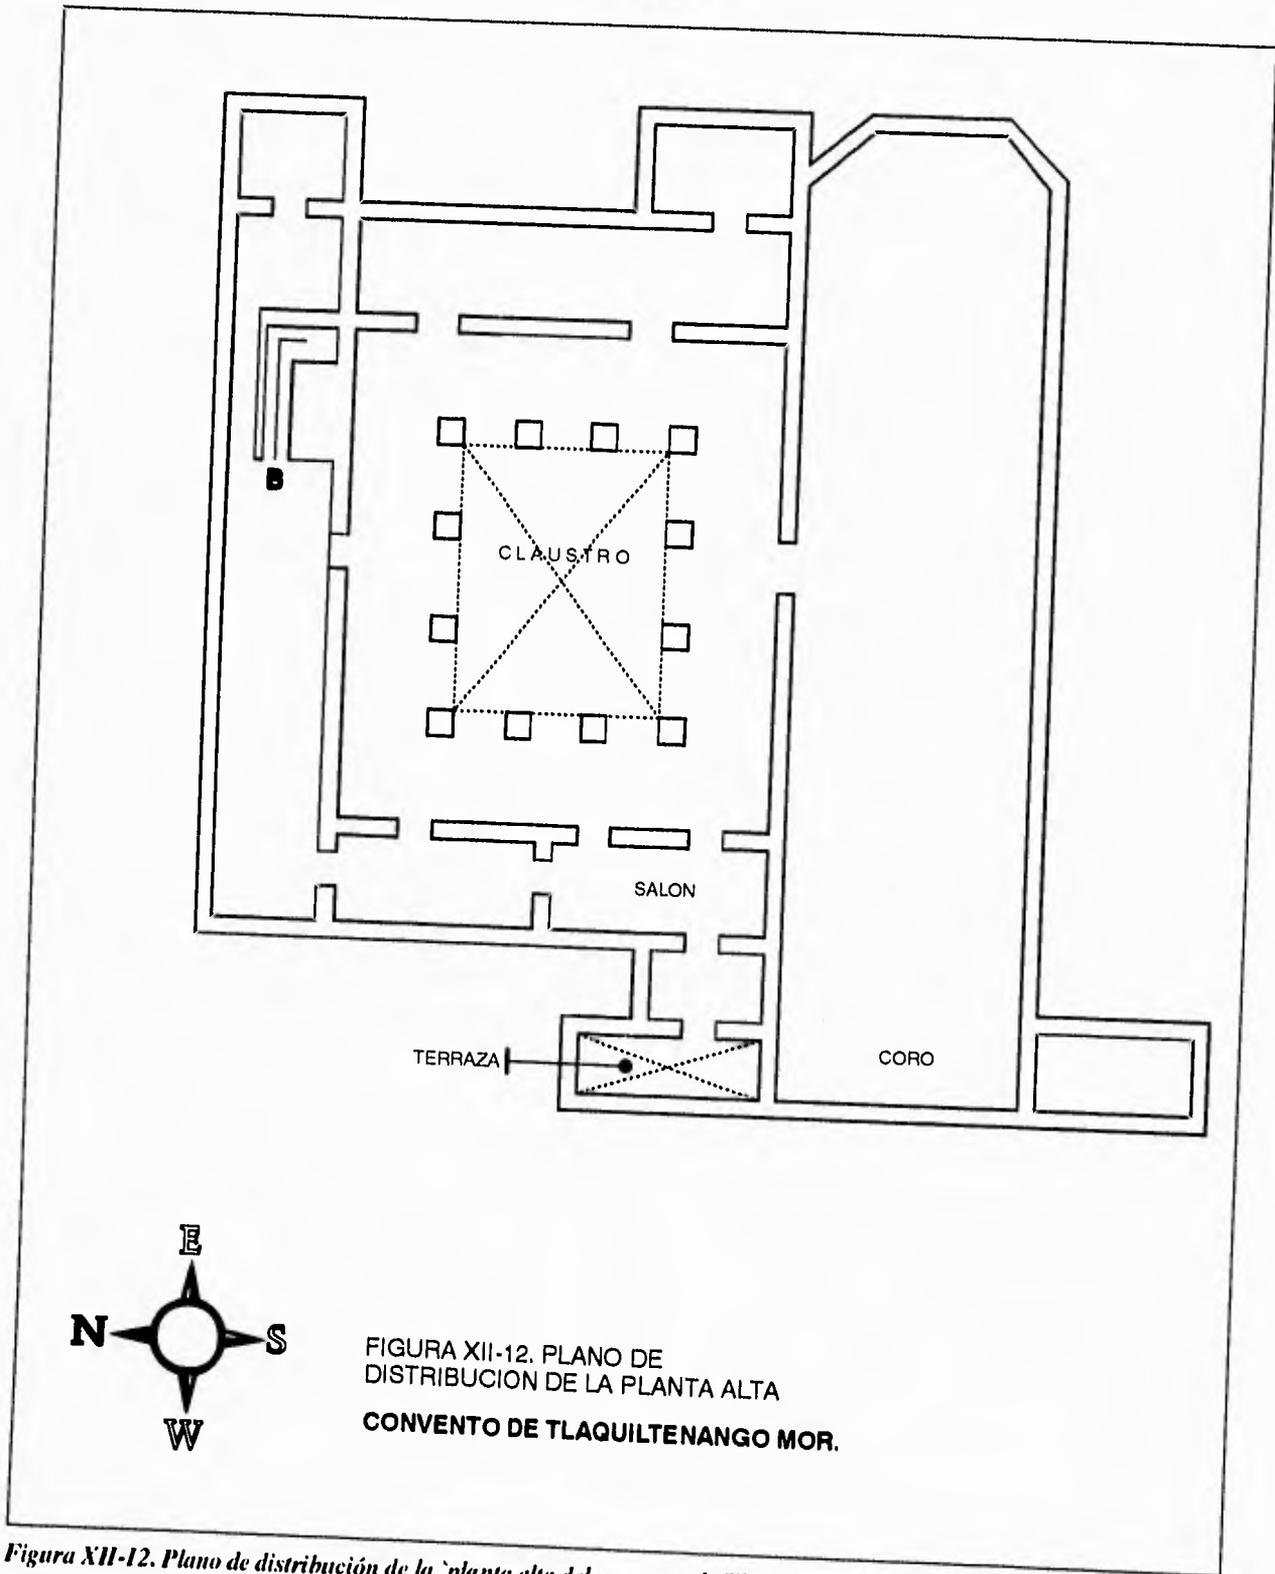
Plano de distribución de la planta alta del convento de Tlaquiltenango.
